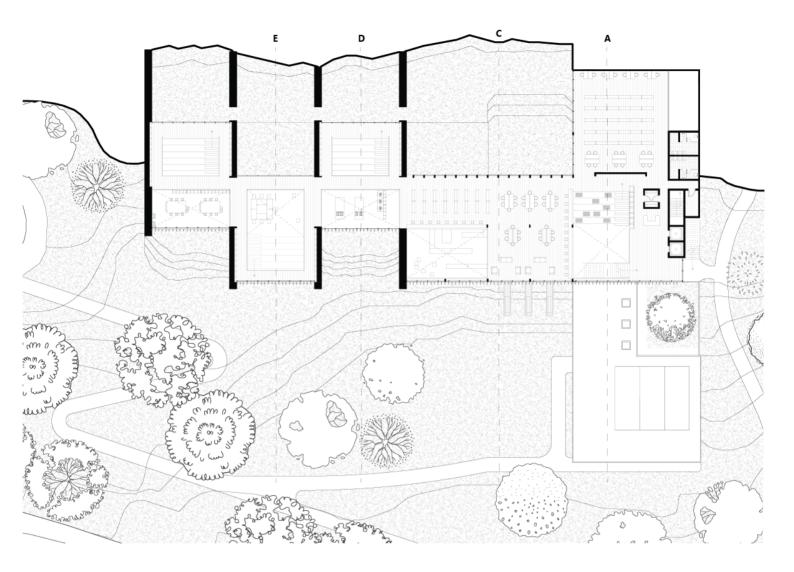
Planta Nivel +7.00m. Elaboración Propia
